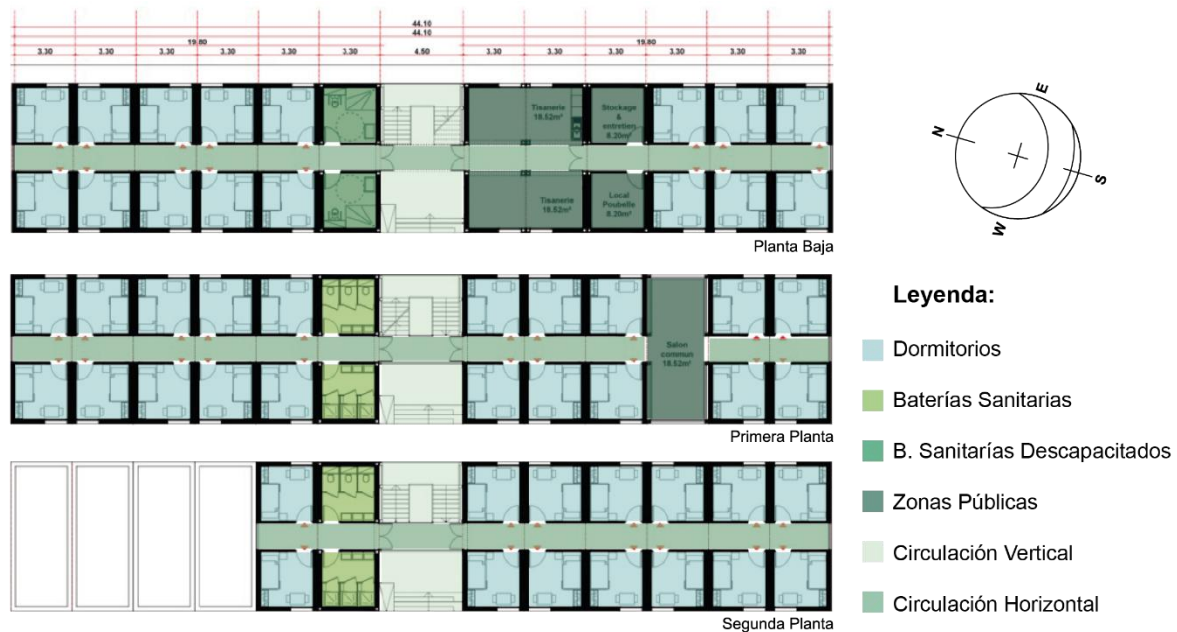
Plantas arquitectónicas y distribución del centro “Promesa al Amanecer”
